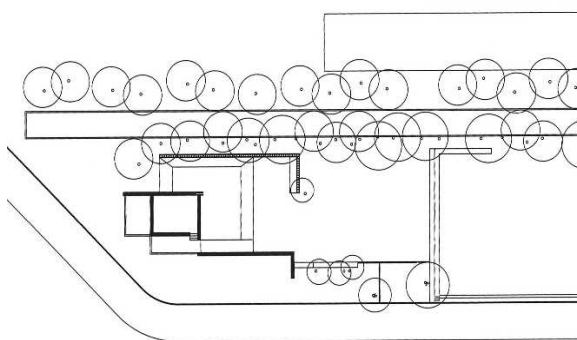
PLANTA DO ESPAÇO– IMAGEM: “BARRAGAN, OBRA COMPLETA”
